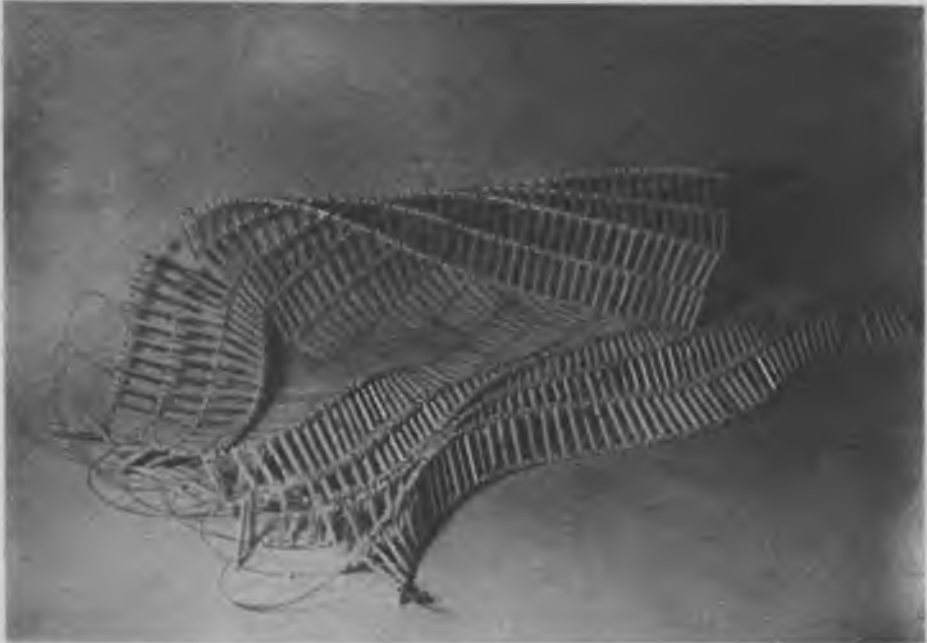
Варианты соединения конструкции с покрытием (предложение В.И. Тимофеева): деревянное покрытие; покрытие из кровельного железа
